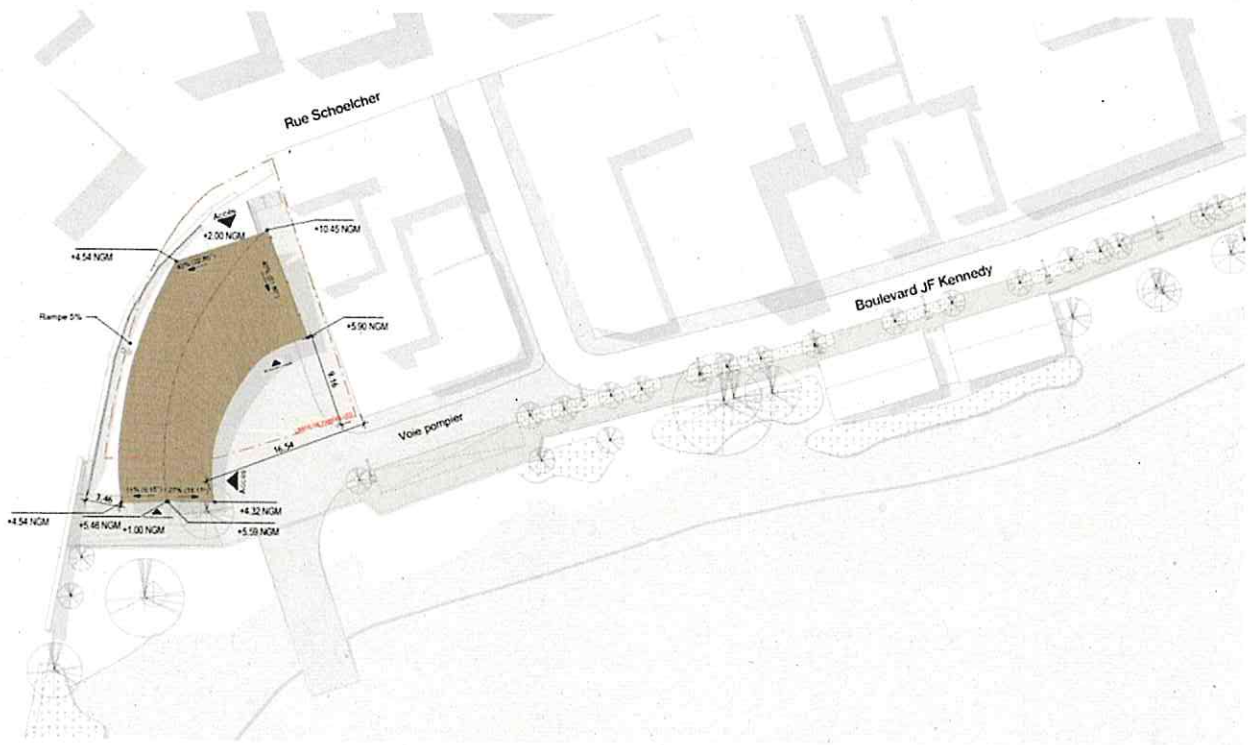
PLAN MASSE - ESPACE GOMMIER
